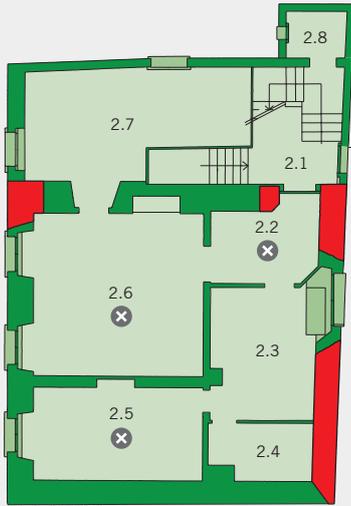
Zug, Dorfstrasse 11, Grundriss des zweiten Vollgeschosses.
